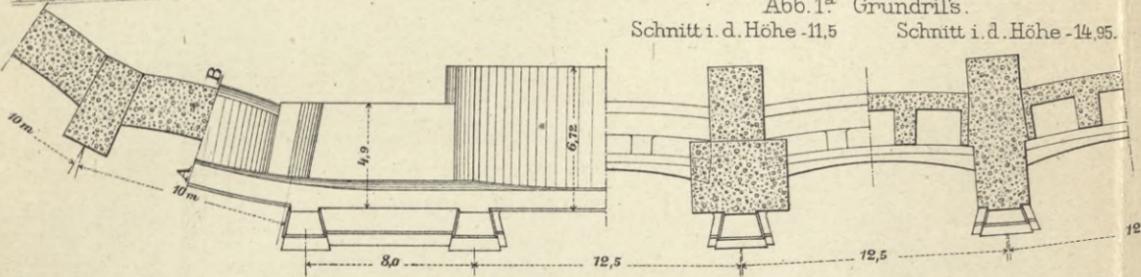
^d Stützmauer a.d. Hochstraße beim Bahnhof Gesundbrunnen. (Berliner Ringbahn) M. 1:300.
